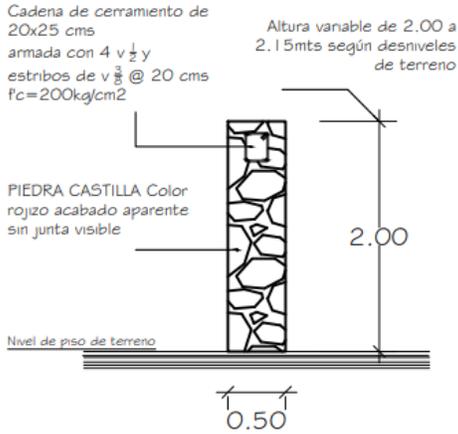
Detalles de la fachada posterior. Escala 1:75.
